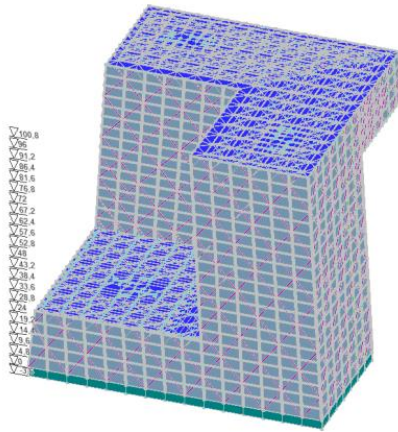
3D вигляд будівлі з ПК SCAD
